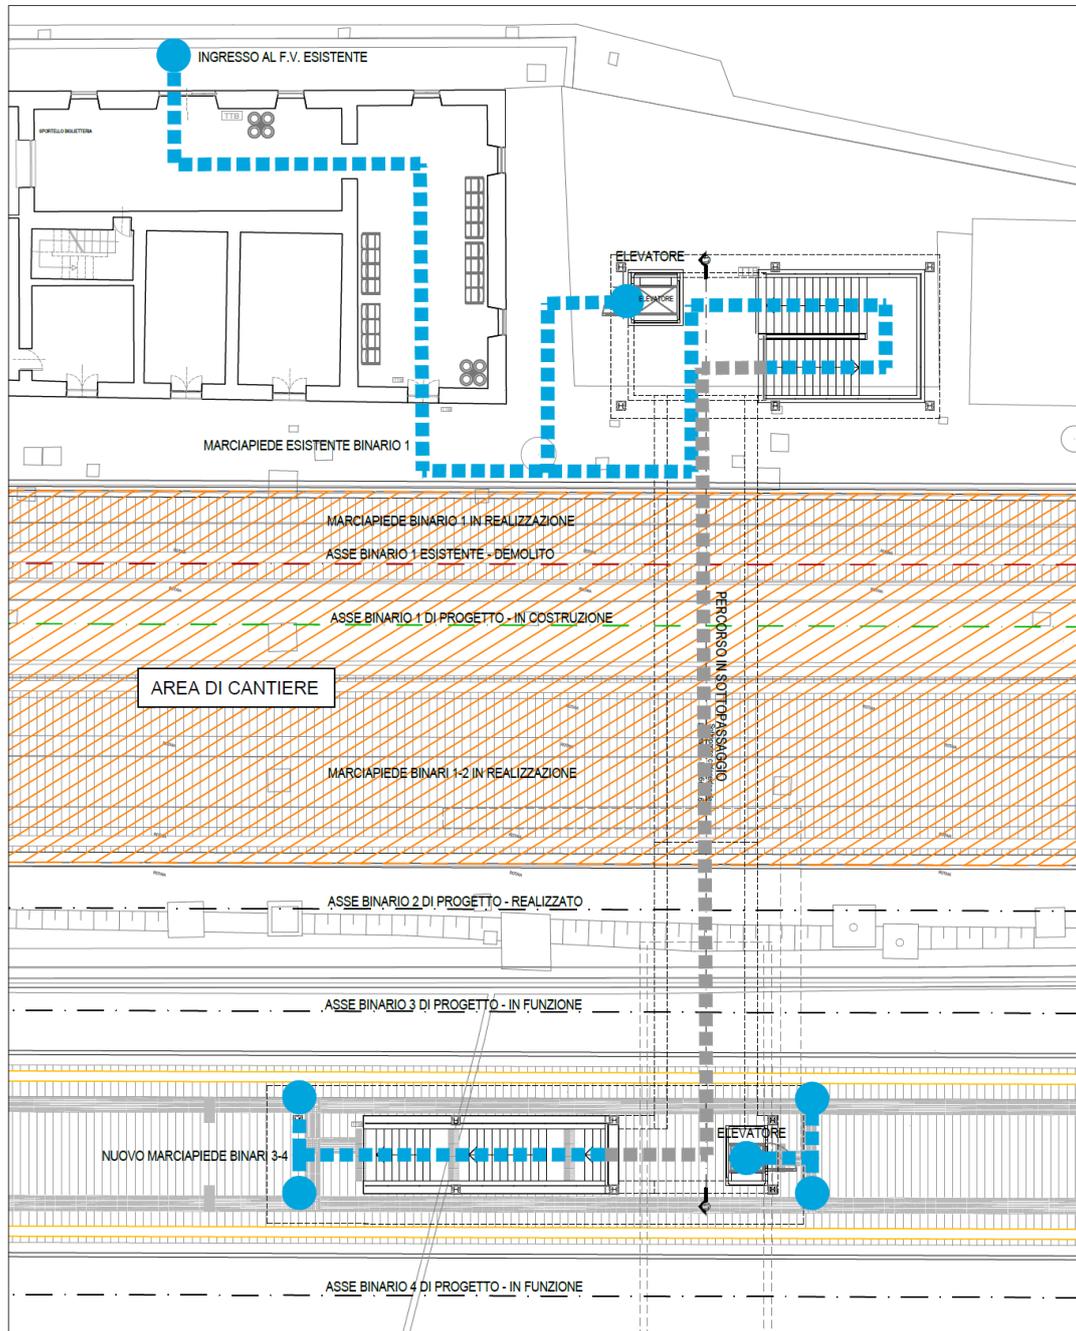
Planimetria di fase 1.2 con percorso protetto (puntinato in blu) dall'ingresso stazione al nuovo marciapiede a servizio dei binari III e IV
